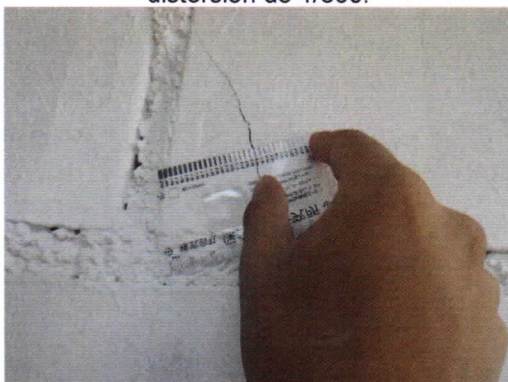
Espesor de grieta de 0.55mm en ladrillo de la cara Sur para una distorsión de 1/550.
